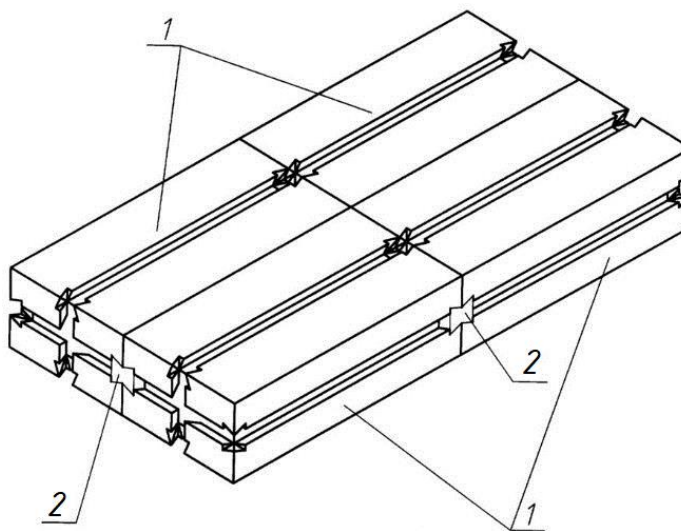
Общий вид сборной конструкции, выполненной из древоблоков: 1 – древоблоки; 2 – связевые элементы
